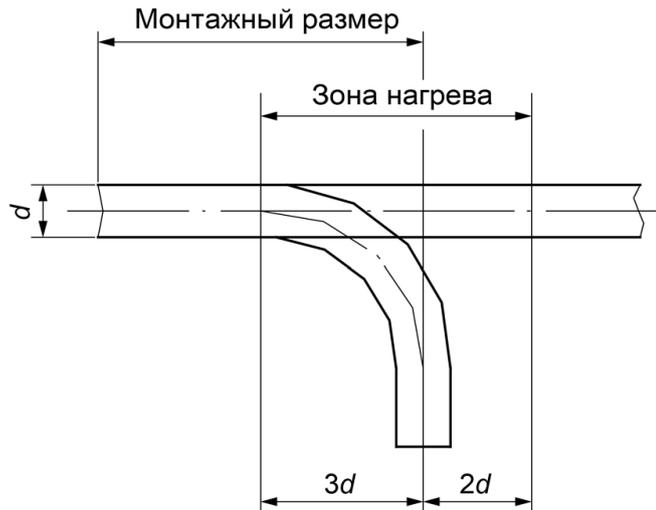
Зона нагрева трубы для выполнения гибки под углом 90°
